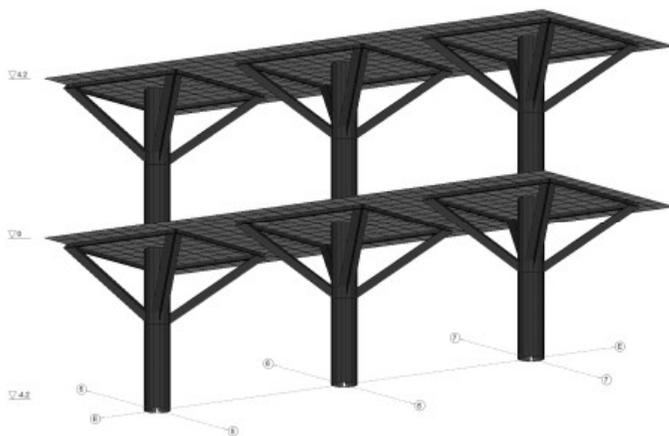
Фрагмент расчетной схемы усиливаемого каркаса здания .
